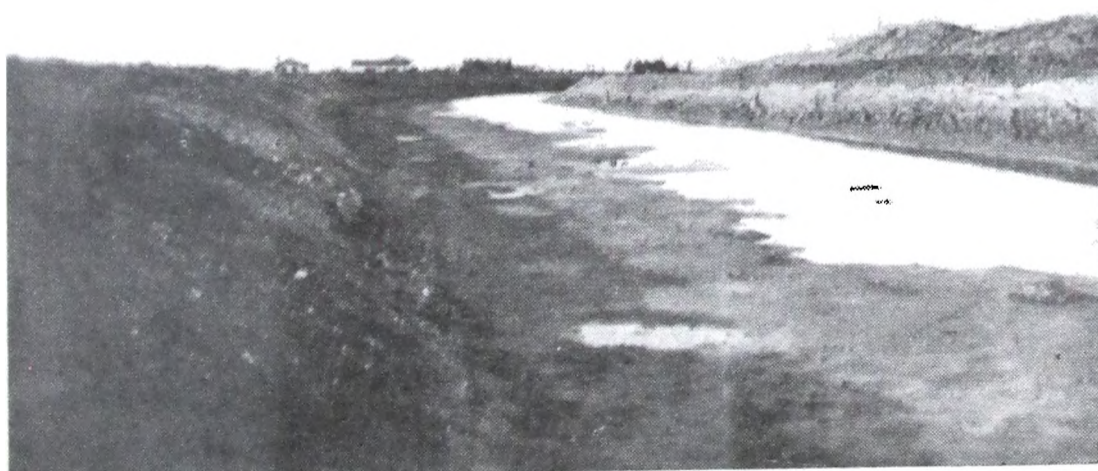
Plan de obras de Castelli. Ramal a la Laguna Lastra, totalmente terminado.
